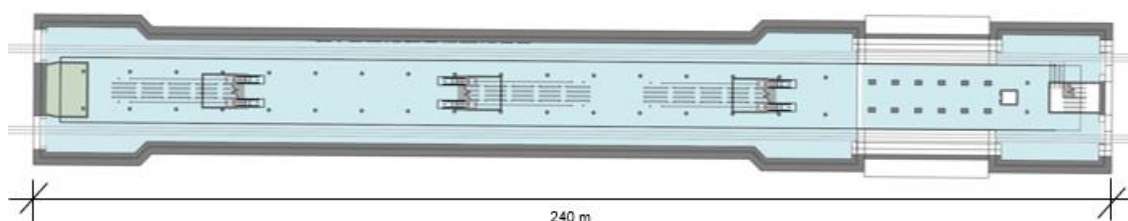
Hp Sternschanze, Var. I – Grundrisse
